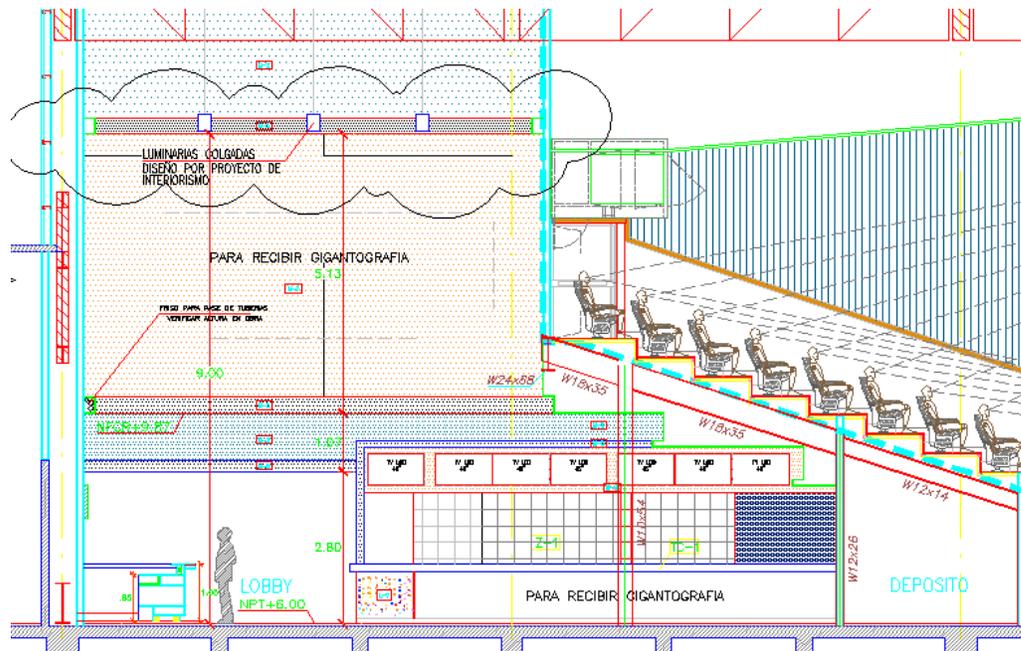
Vista de corte de lobby 1. Plano de arquitectura.
